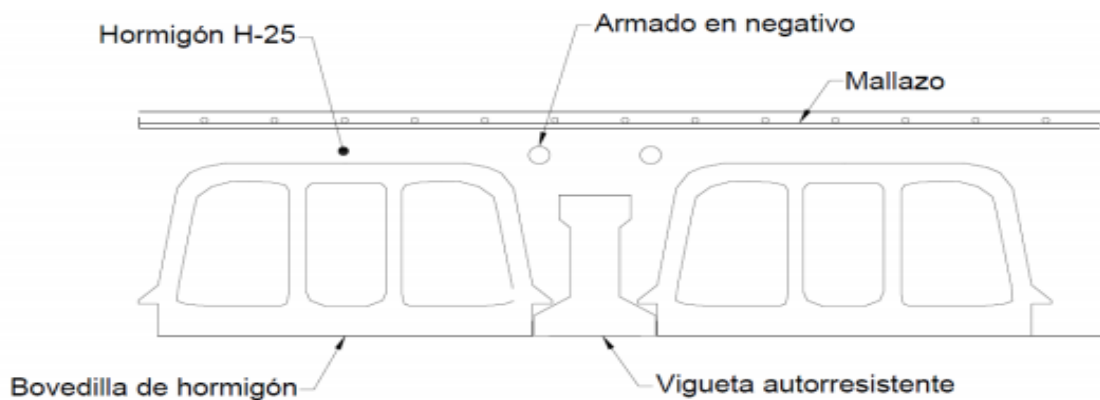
Detalle Forjado Oficinas
